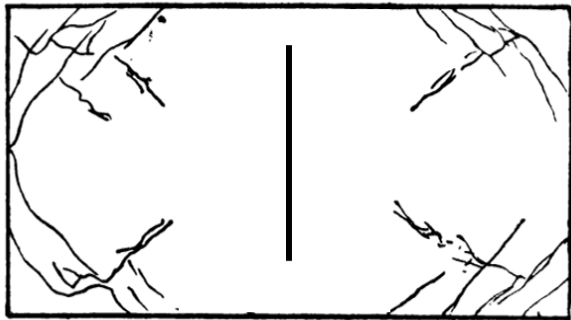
Схема излома плиты, испытываемой под нагрузкой
